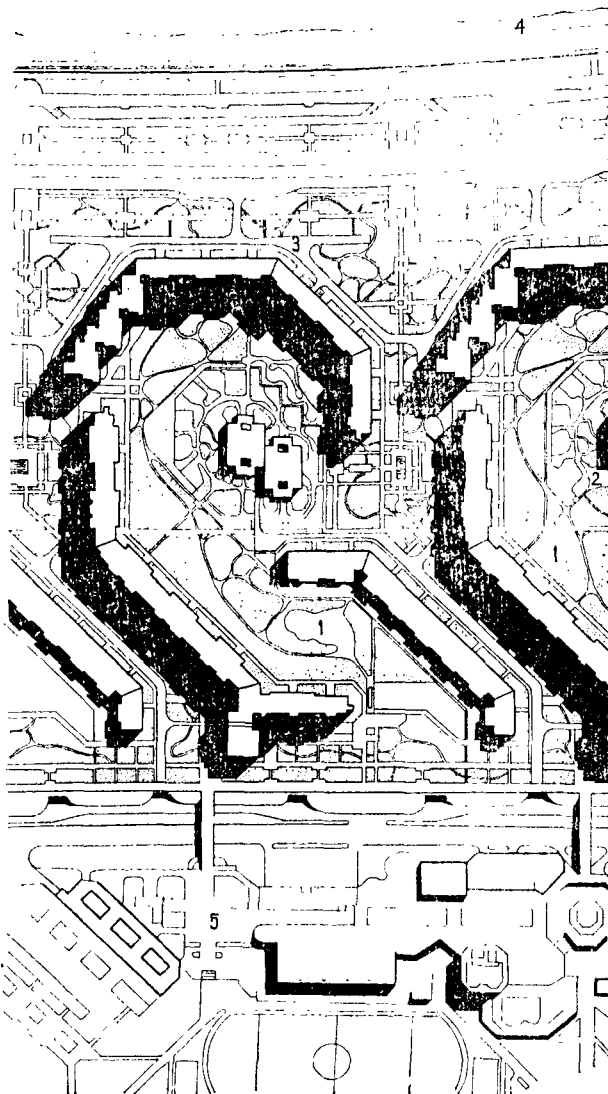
Экспериментальный жилой комплекс. Фрагмент генплана
